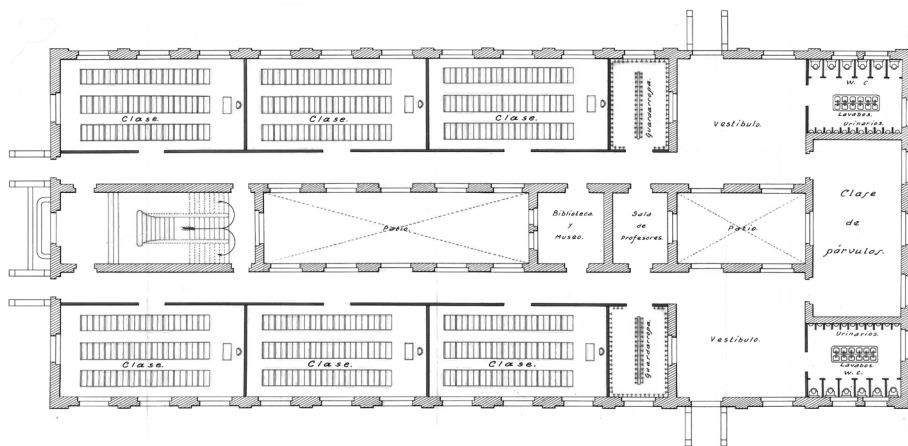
, Planta Baja. Proyecto 1933, Vicente Pascual
